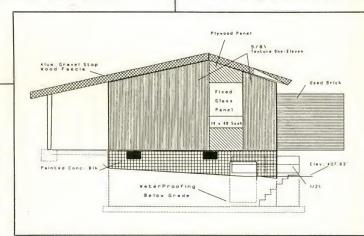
Der Bauplan wurde auf dem Laser Printer 8 gedruckt
